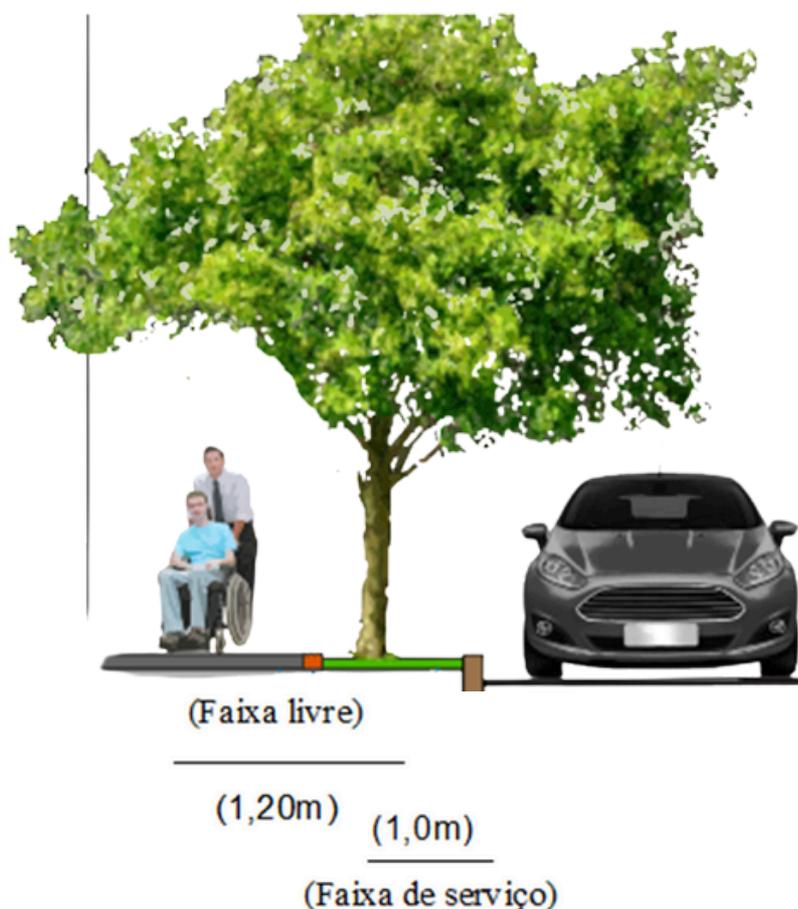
Detalhe da faixa livre mínima de 1,20 m, pavimentada, para o trânsito de pedestre na calçada.
